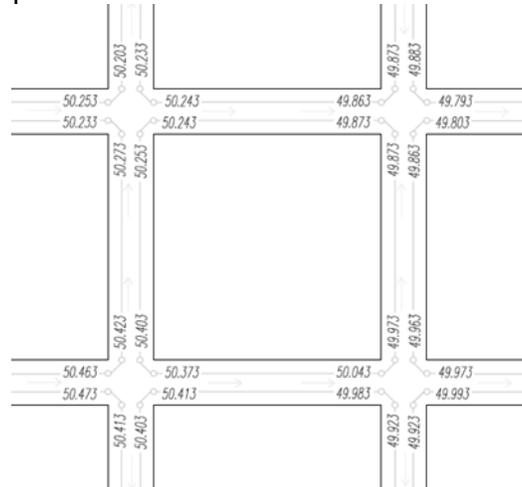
a Levantamiento topográfico sobre pavimento.
